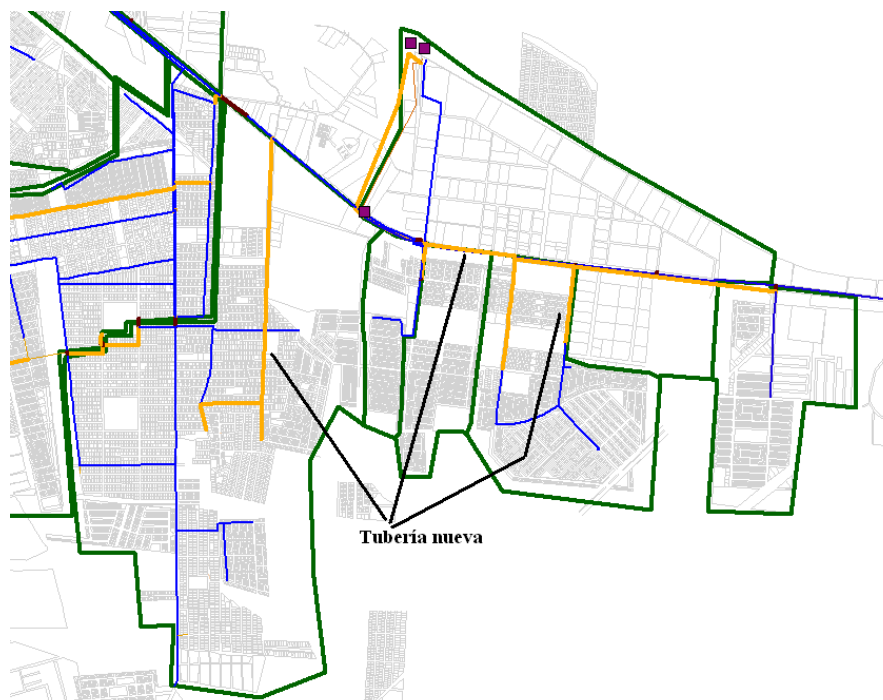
Tubería nueva en la zona de influencia de la Planta Potabilizadora 2
